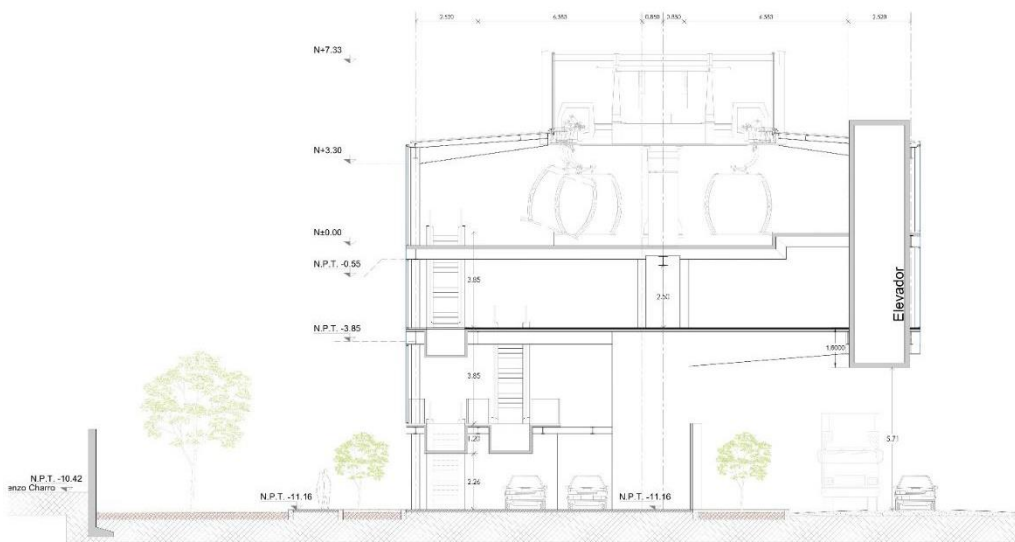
Corte Transversal Estación 4 Lienzo Charro
